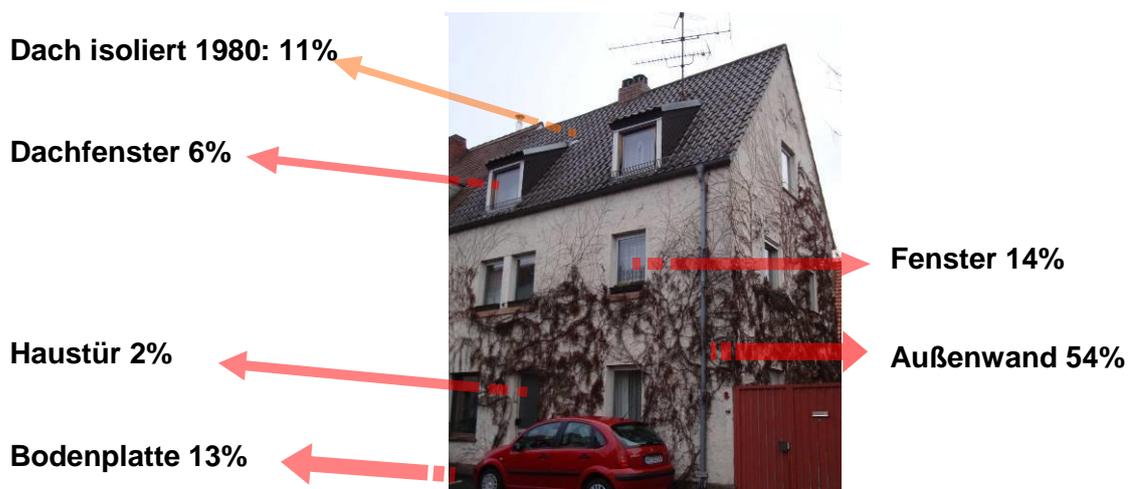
Verluste an einem typischen Bestandsgebäude mit ausgebautem Dach
